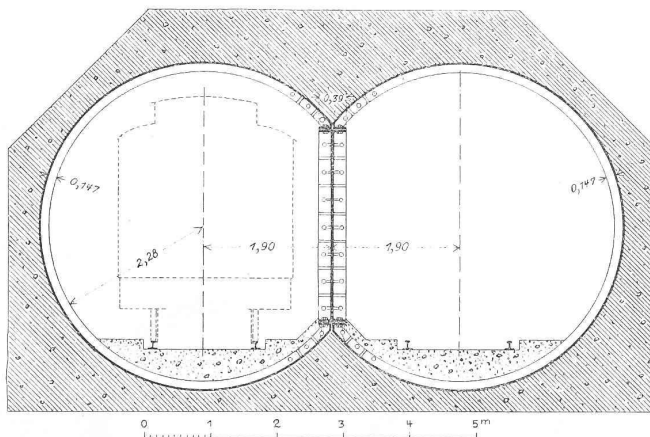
Querprofil des Tunnels unter dem Harlemfluss. — 1 : 100.
